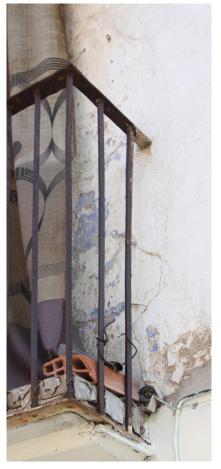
Detalle Barandilla de forja y estructura sotabalcón. Calle de los Ángeles (Pastor, R. 2011).
